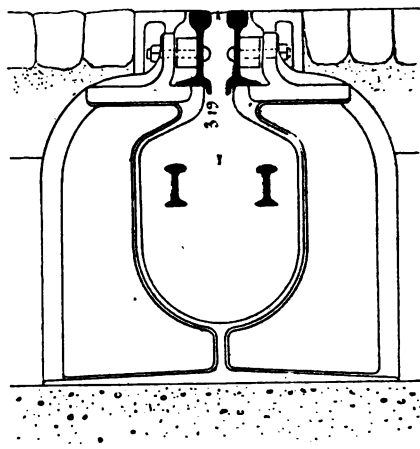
Caniveau de Berlin, système Thomson-Houston. — Élévation d'un cadre en fonte.
